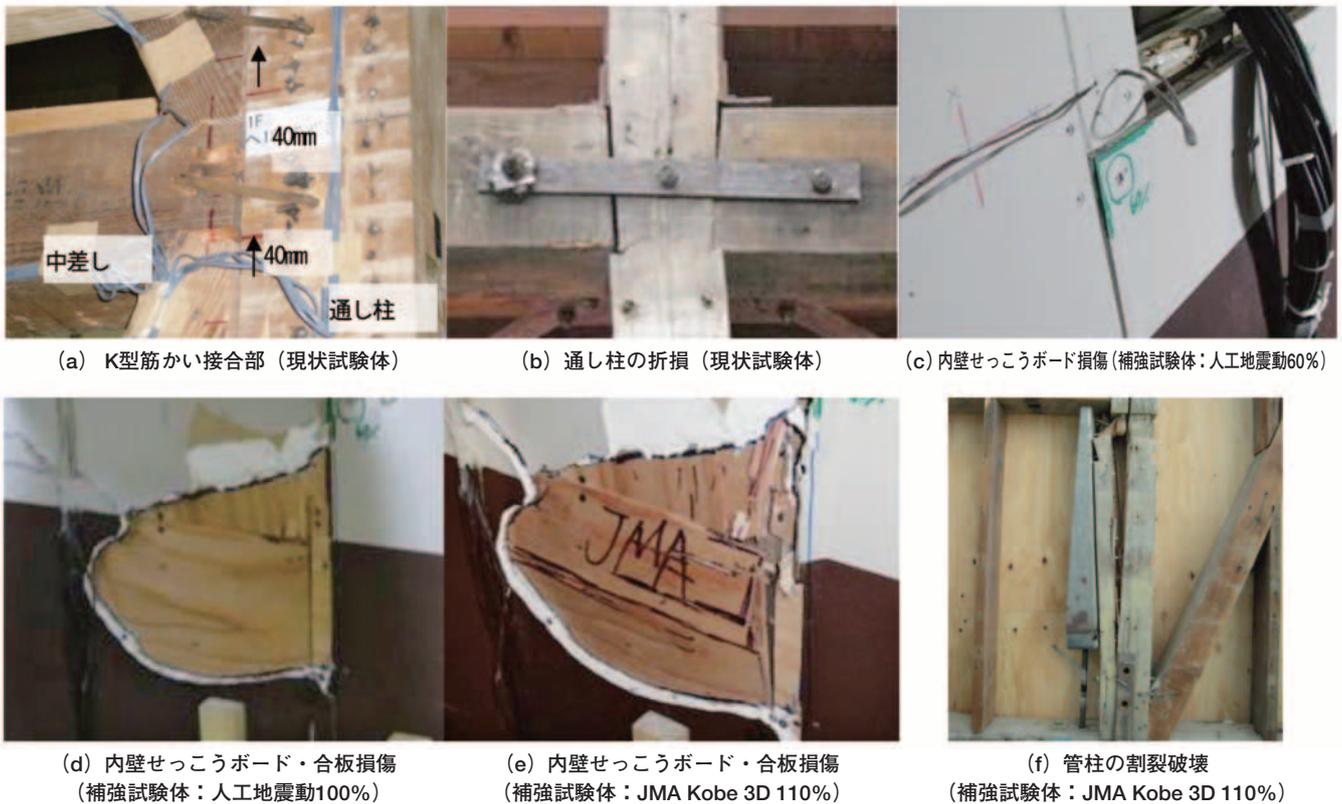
損傷状況 (a, b: 現状試験体, c~f: 補強試験体)
